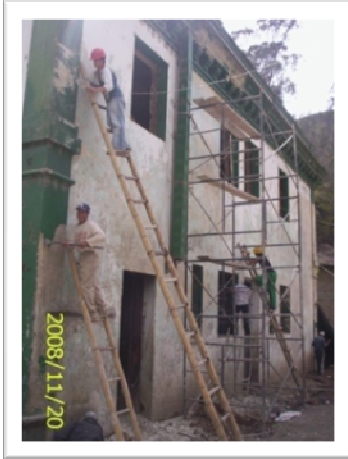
Enchape de Columnas y Vigas con Piedra Bola
